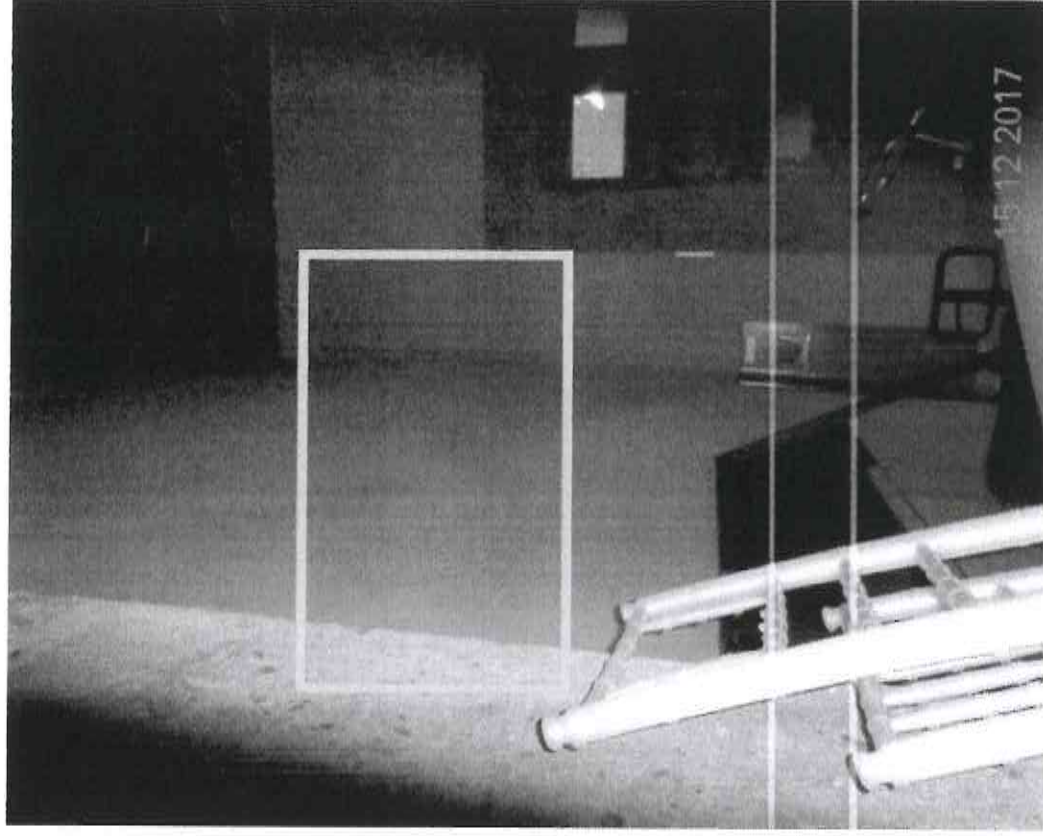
Vista del sector oriente de la fachada del museo por la calle de Moneda, donde se señala la junta constructiva de esa zona.
